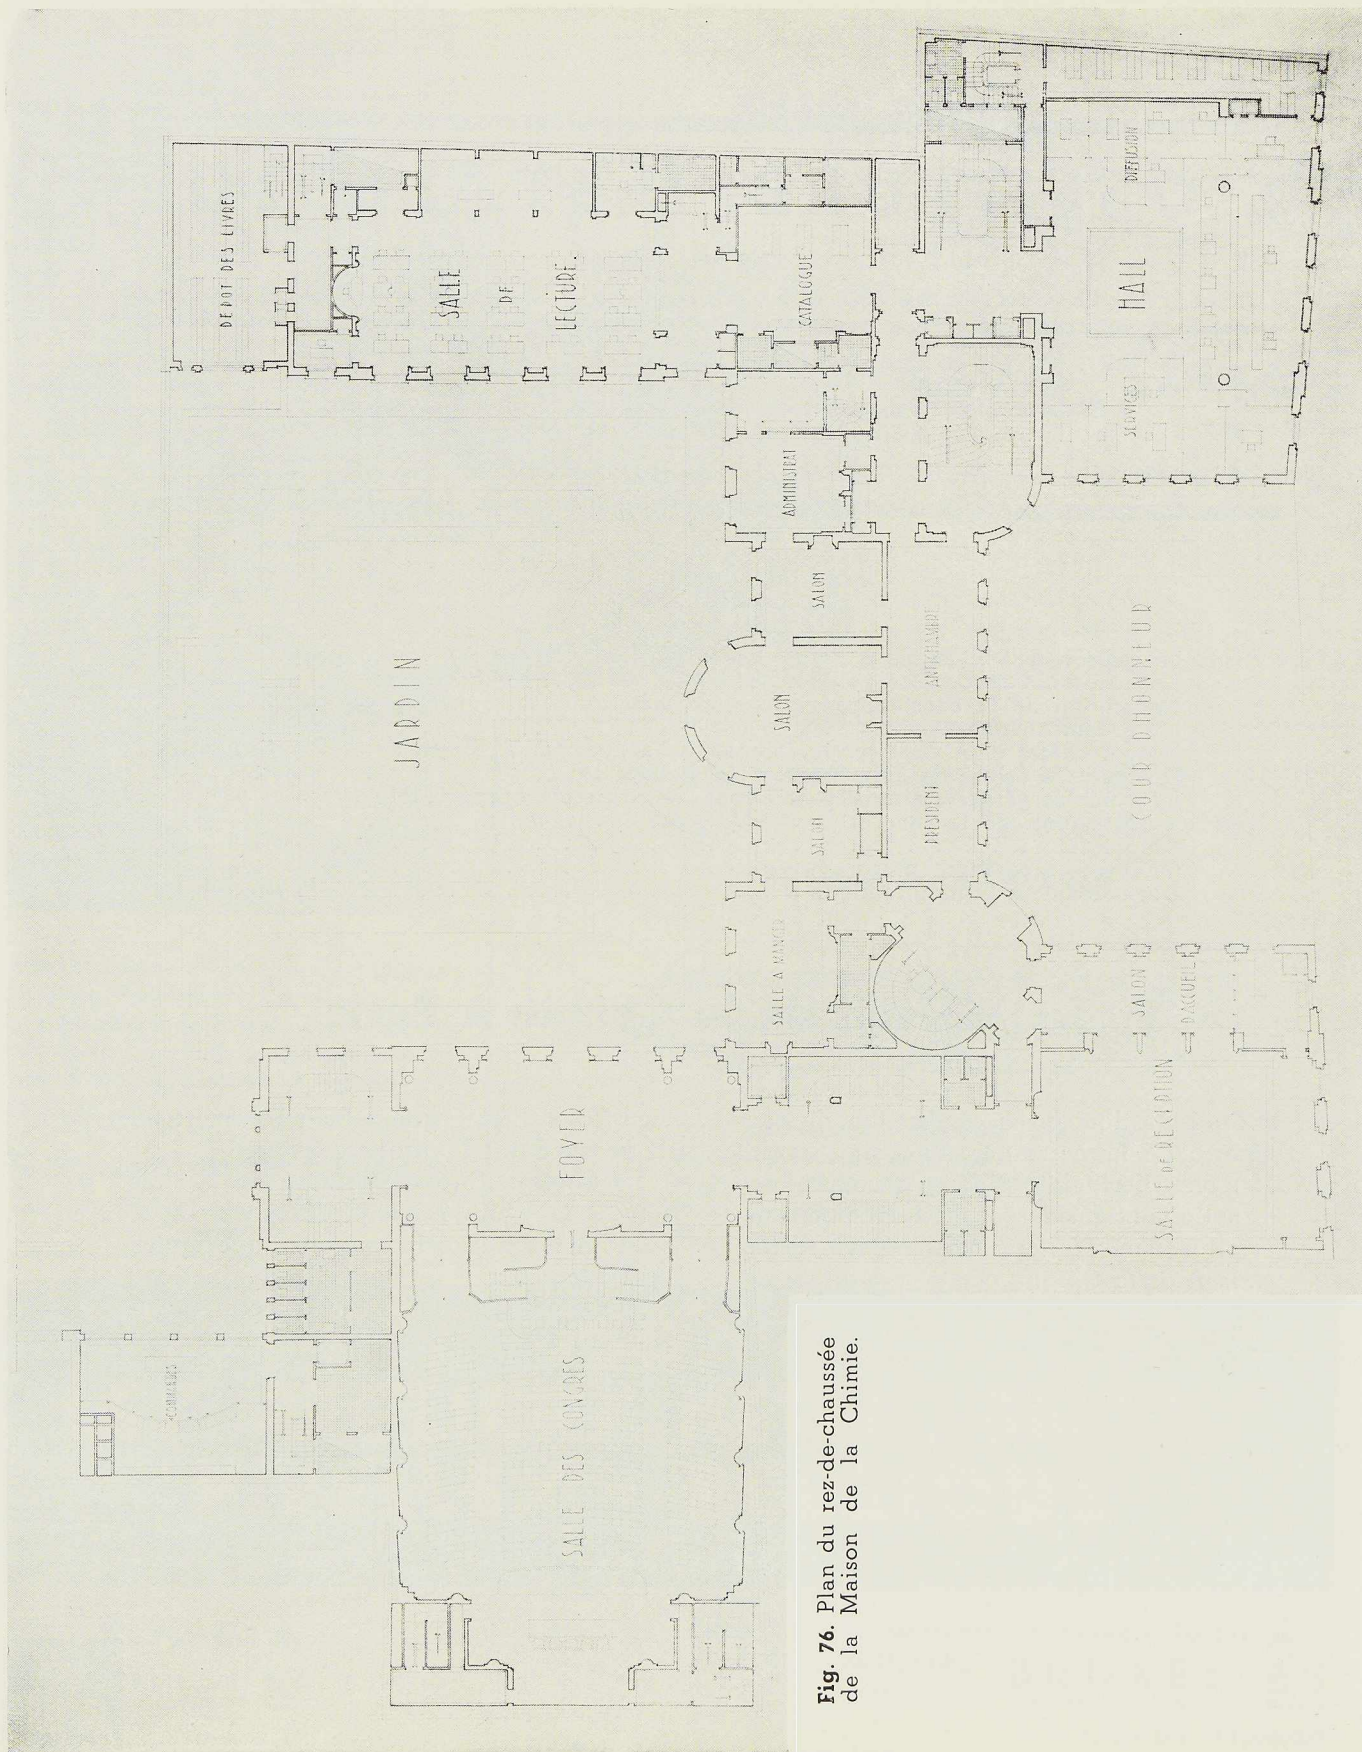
Plan du rez-de-chaussée de la Maison de la Chimie.
